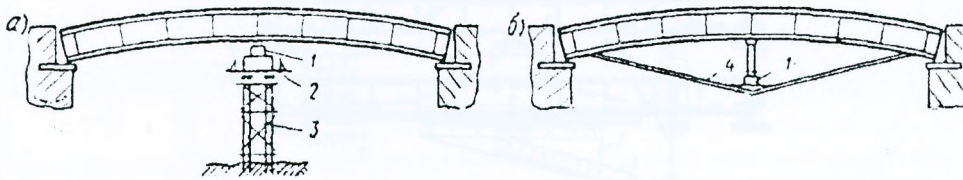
Схемы разгрузки ферм: 1 – домкрат; 2 – опорная шпальная клетка; 3 – временная опора; 4 – шпренгель.
